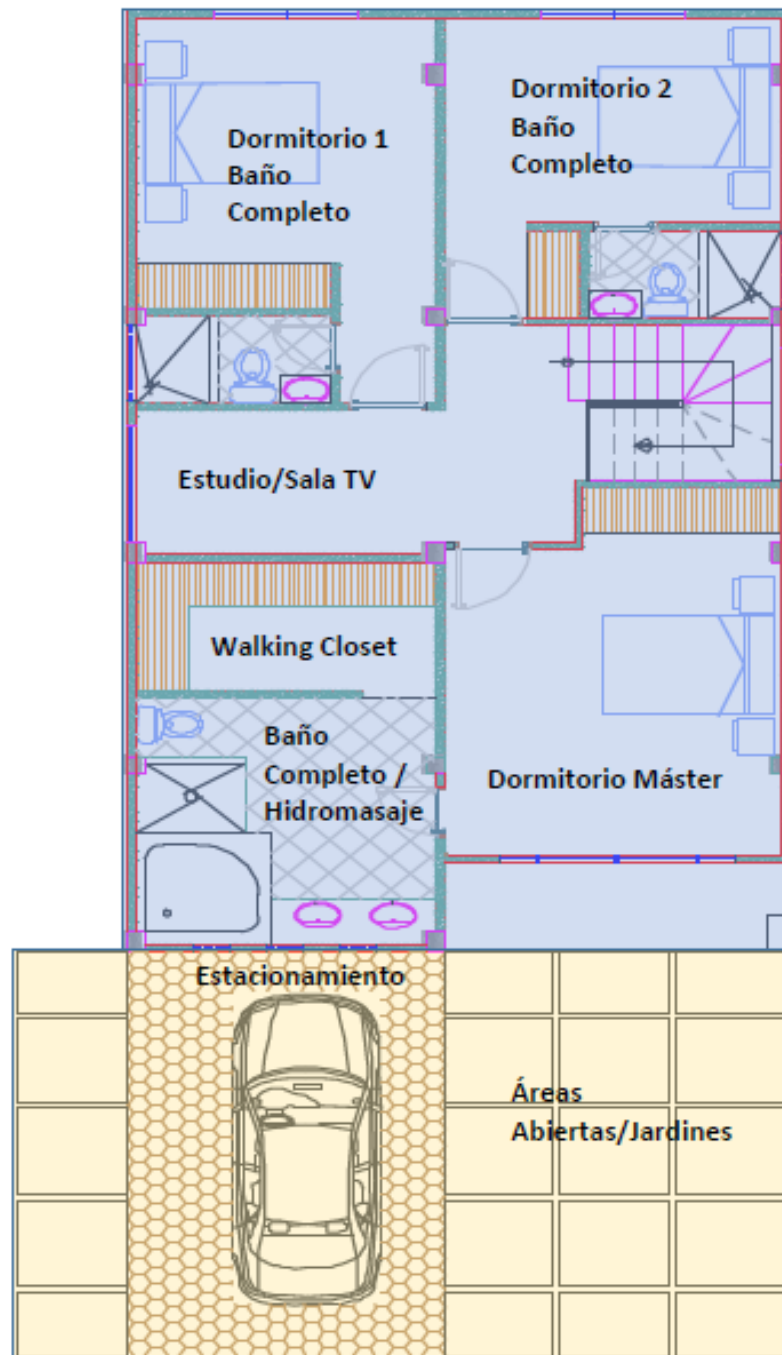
3 Planta Alta Vivienda Tipo No. 1
